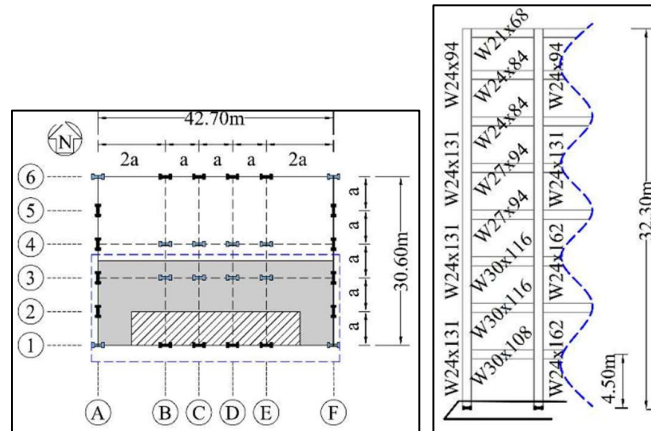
Vistas en planta y elevación del modelo estructural considerado (Torres-Rodas et al., 2021)
